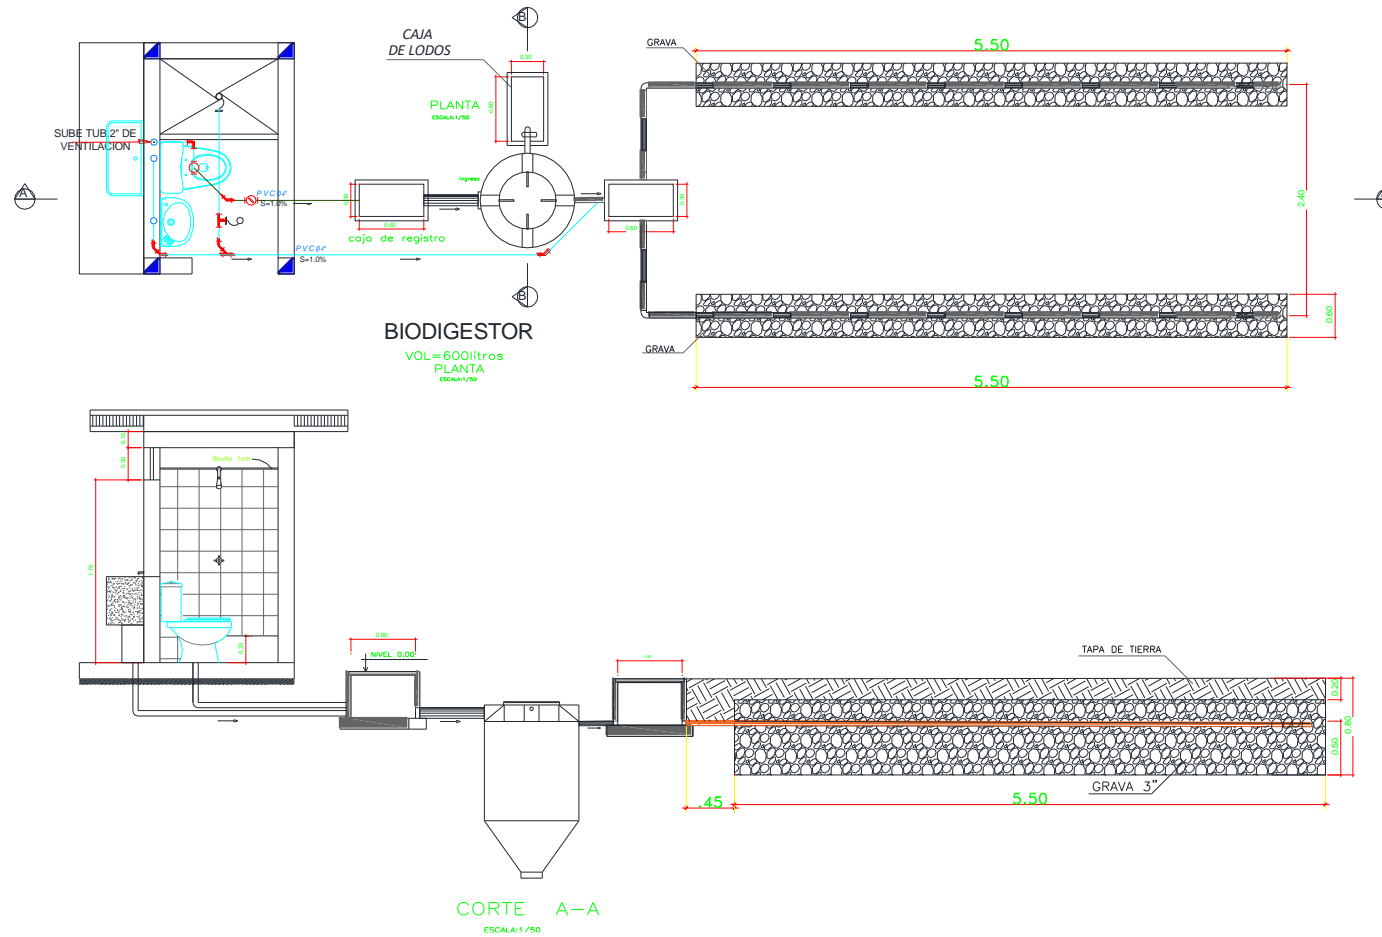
Plano de planta y corte del sistema completo de saneamiento básico.
